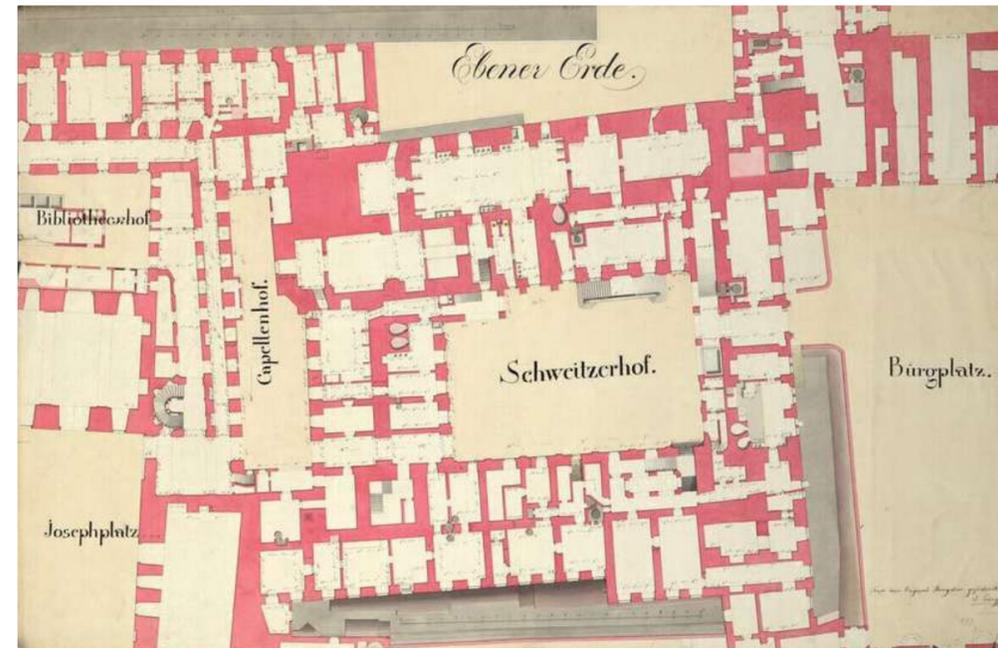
Grundriss der Hofburg in Richtung Südwesten
